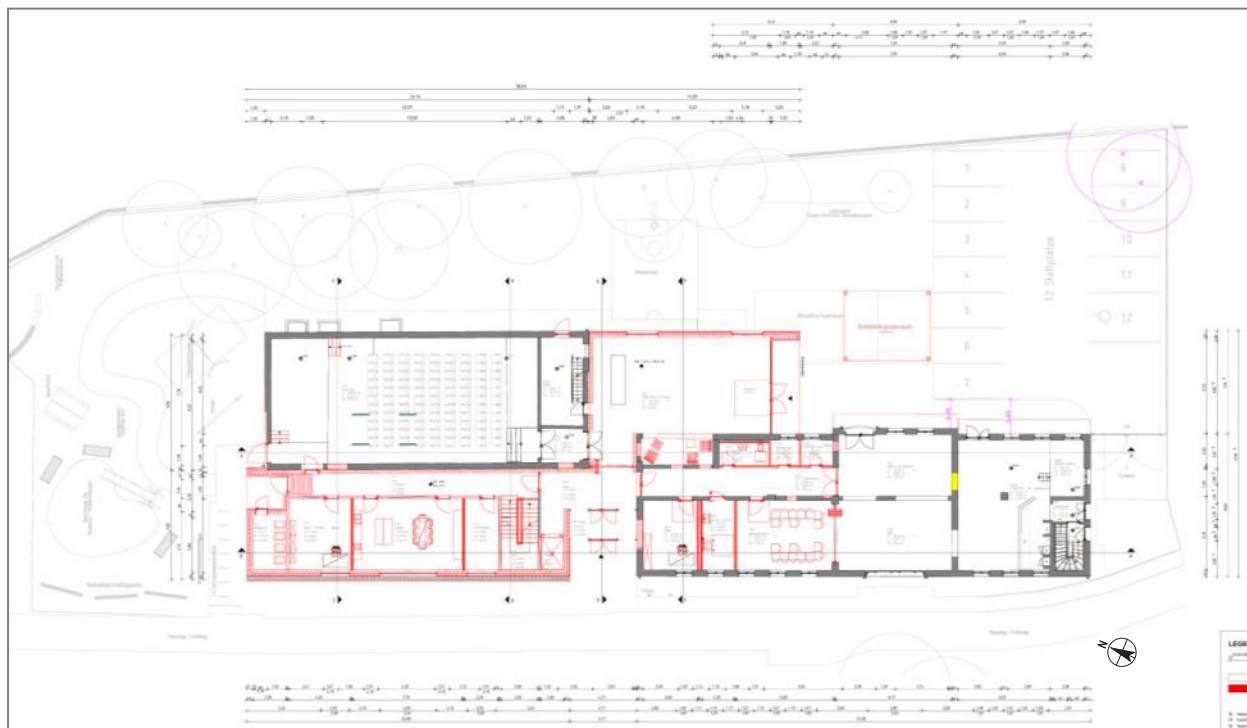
Ausschnitt - „Entwurfsplanung - Grundriss EG“ (Datum: 04.12.2025, [20]), unmaßstäblich
